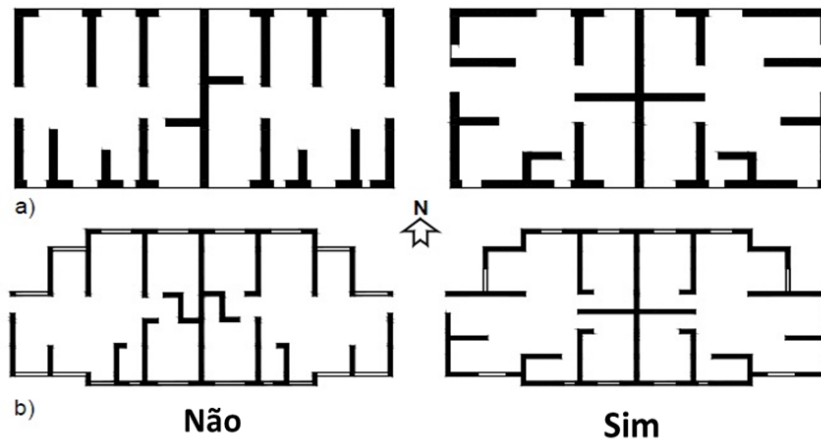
Distribuição de paredes em planta (Meli e Brzev (2011)).
